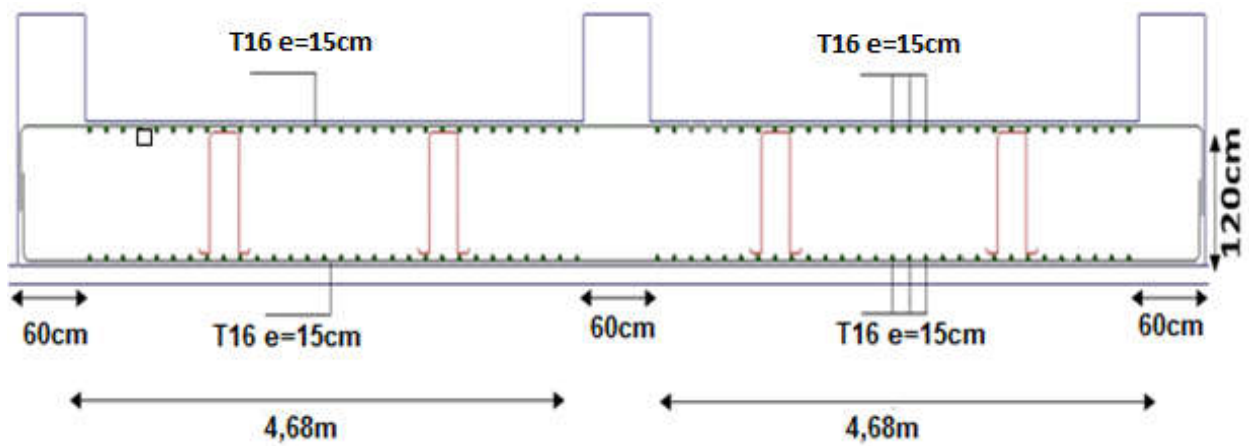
Ferrailage du radier général  $e_p=70$  cm
